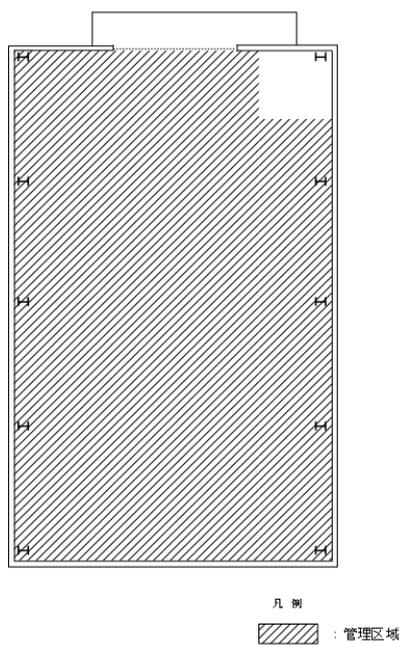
1 第1～第14廃棄物貯蔵庫平面図
